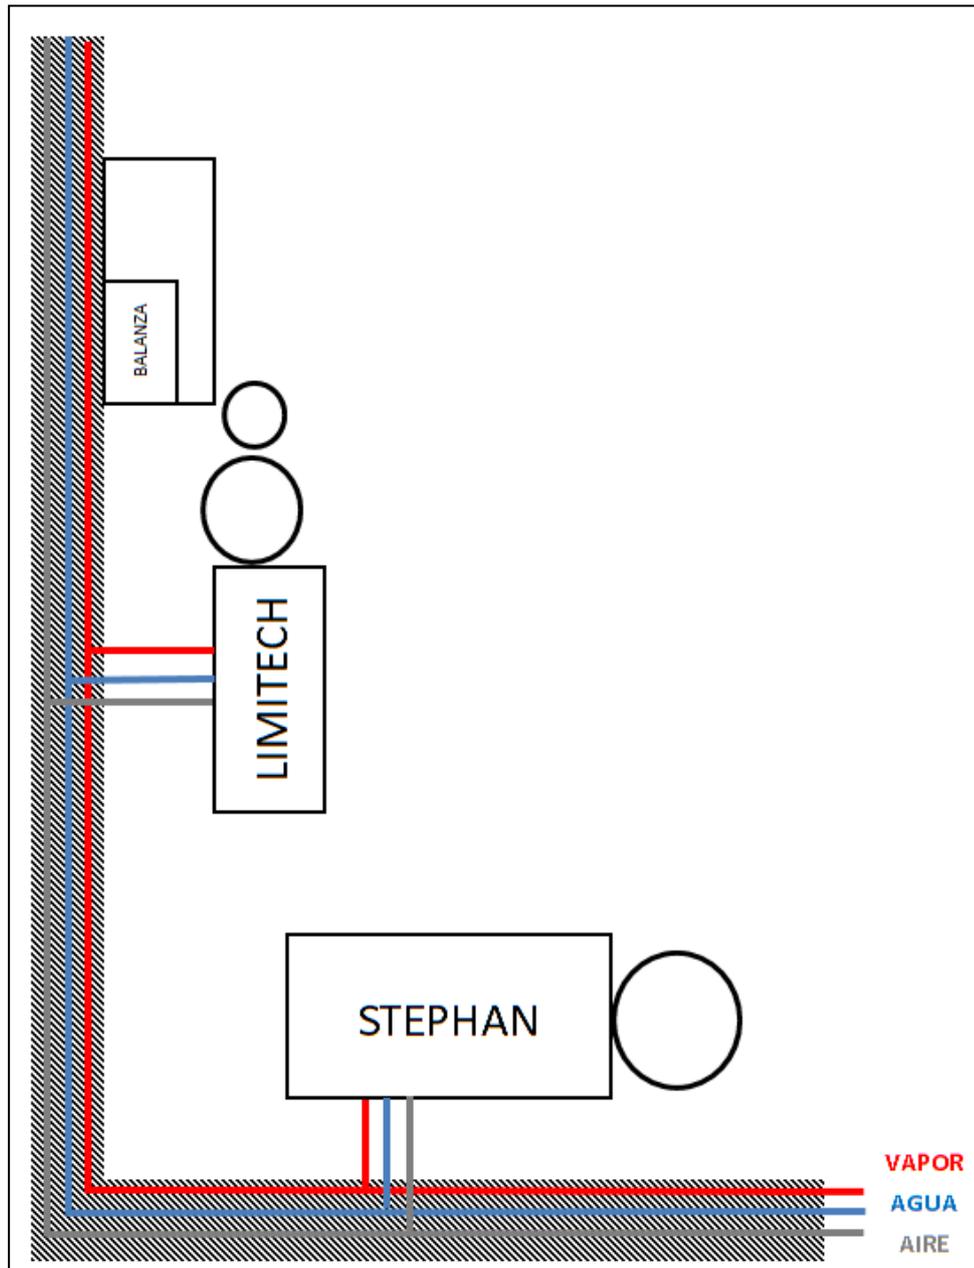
Vista en planta del sector de elaboración de aderezos a escala piloto. Arla Foods Ingredients S.A.
